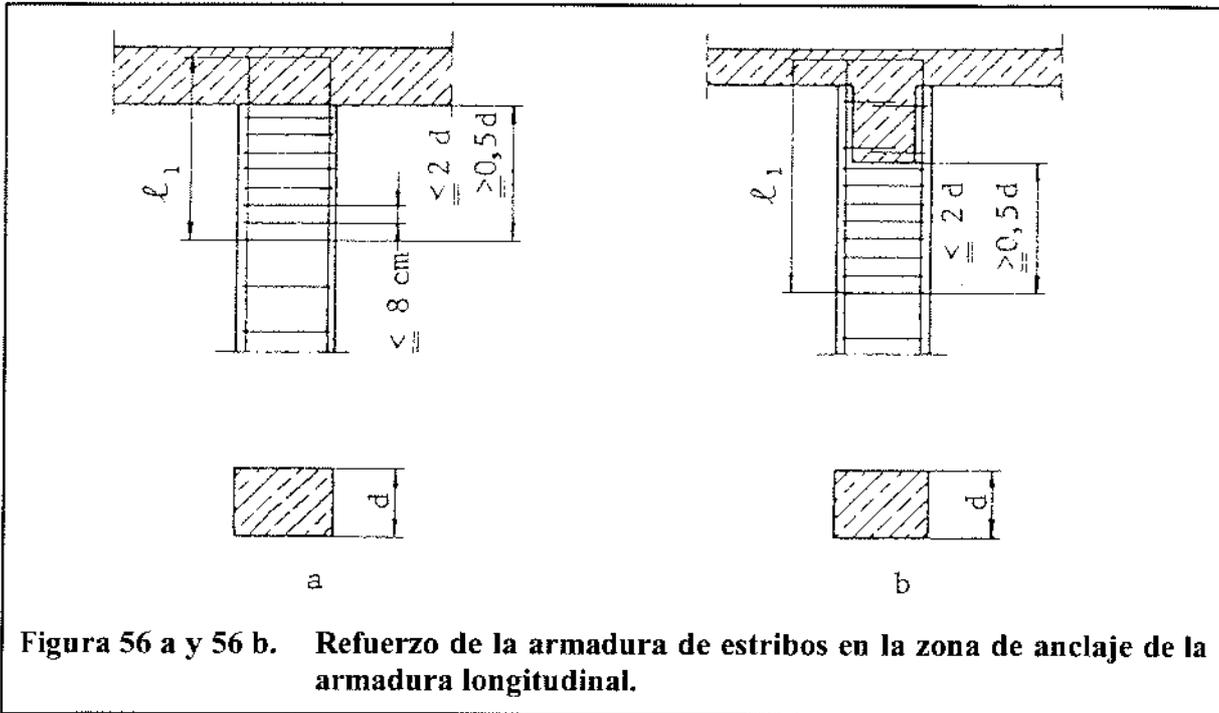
a y 56 b. Refuerzo de la armadura de estribos en la zona de anclaje de la armadura longitudinal.
